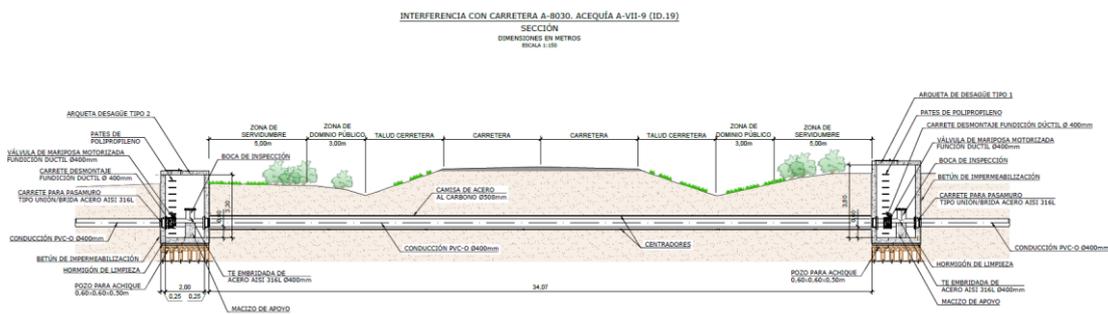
Sección tipo de la hinca bajo el canal de riego
